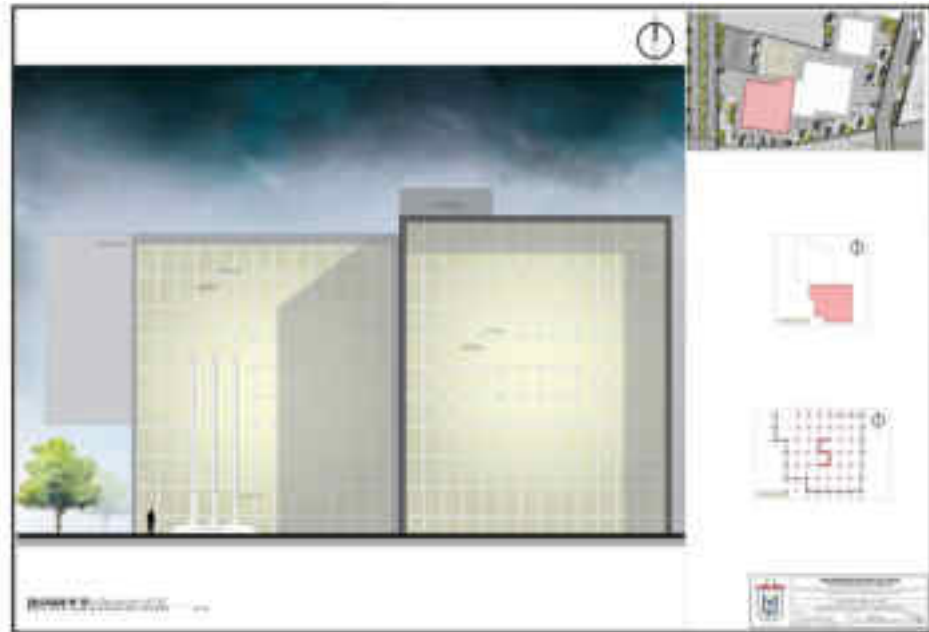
Plano de elevaciones 2 del bloque N° 01
